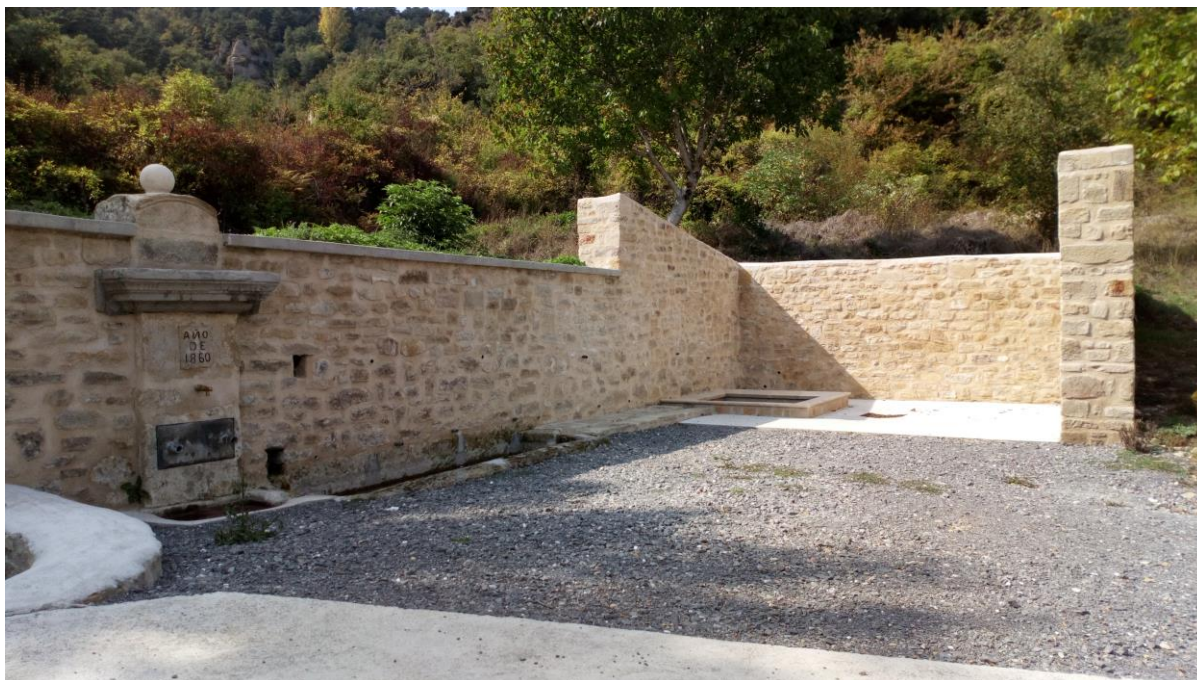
Estado actual Fuente-Abrevadero-Lavadero
